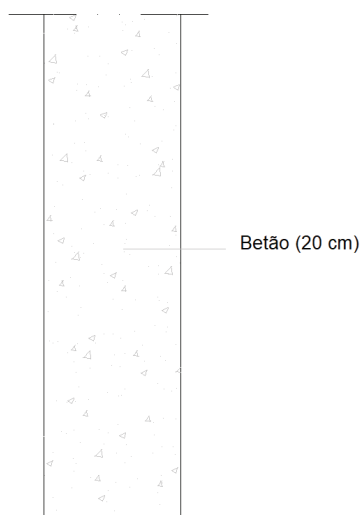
Pormenor construtivo da parede interior tipo XI (nível de água)
